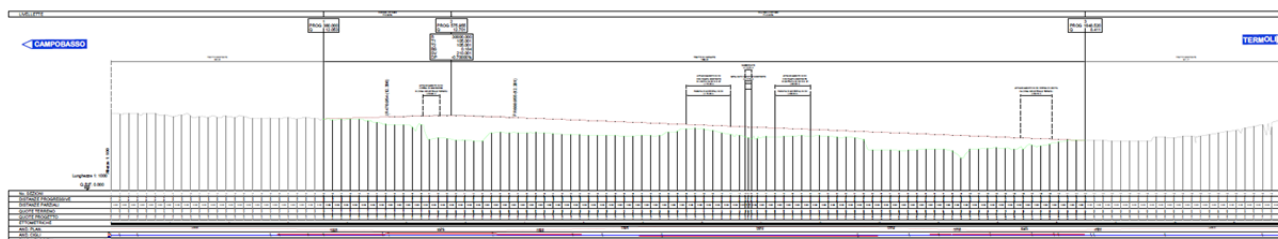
Andamento altimetrico dell'asse stradale
